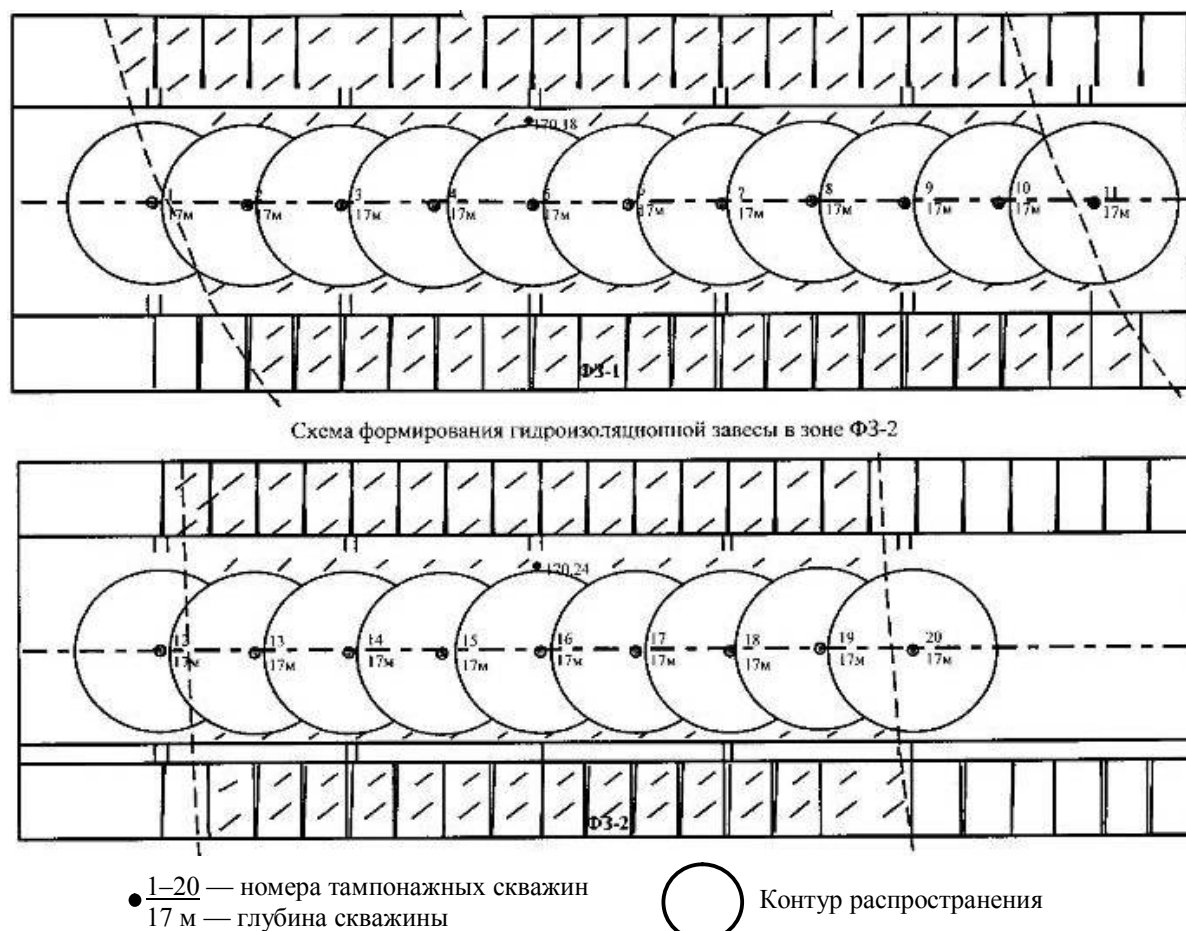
Схема формирования гидроизоляционной завесы в водопрводящих зонах Ф3-1 и Ф3-2
